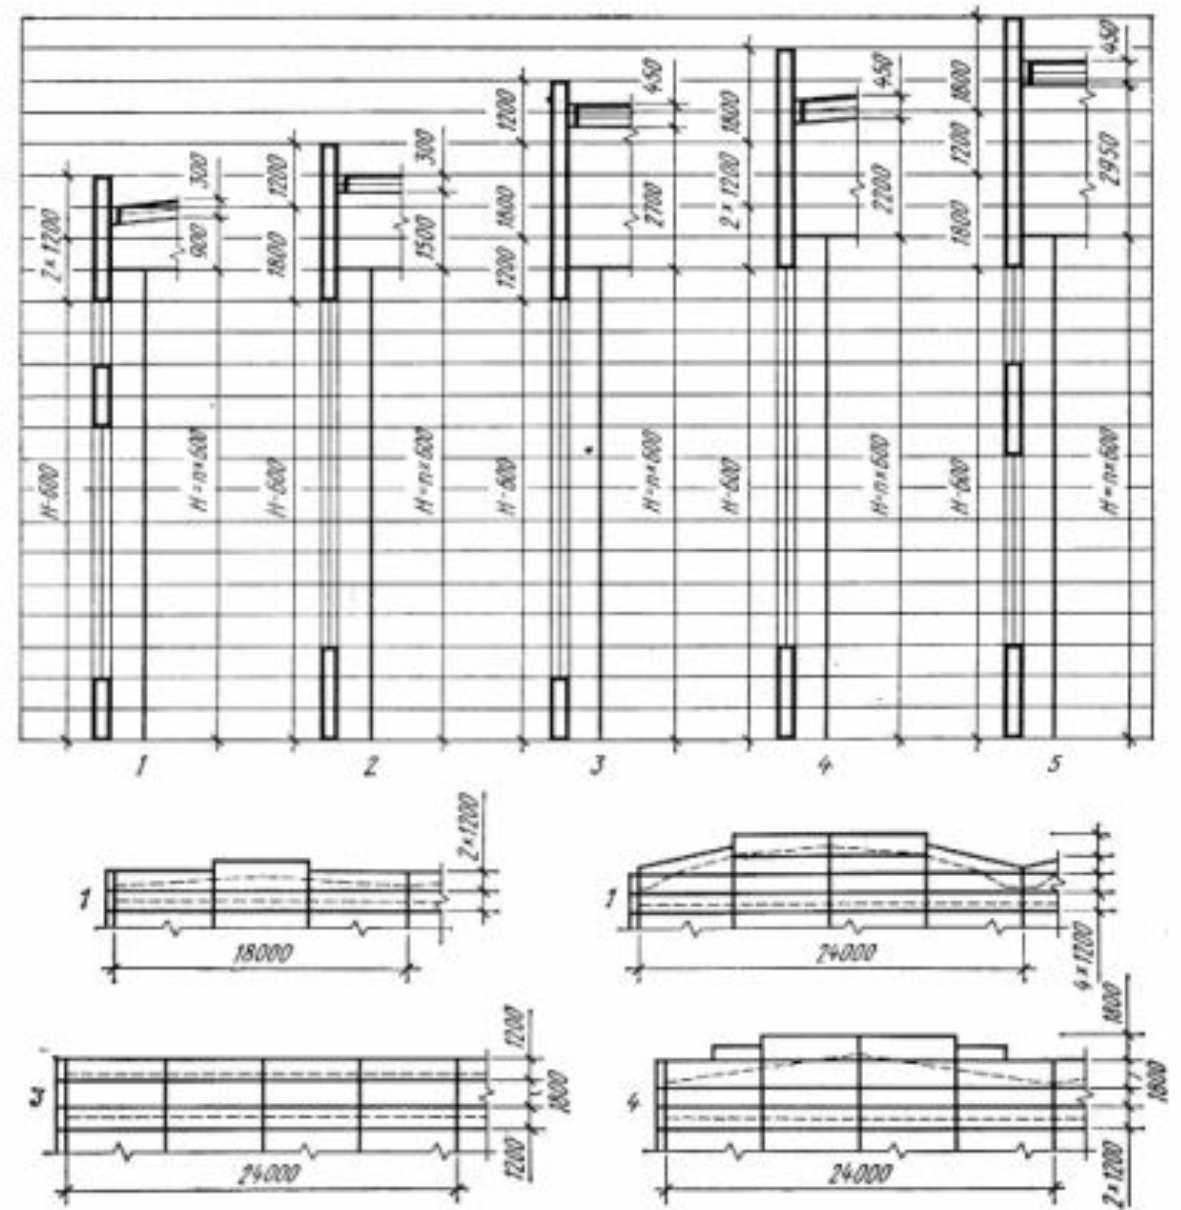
Схеми розкладки панелей у стінах одноповерхових будівель:
